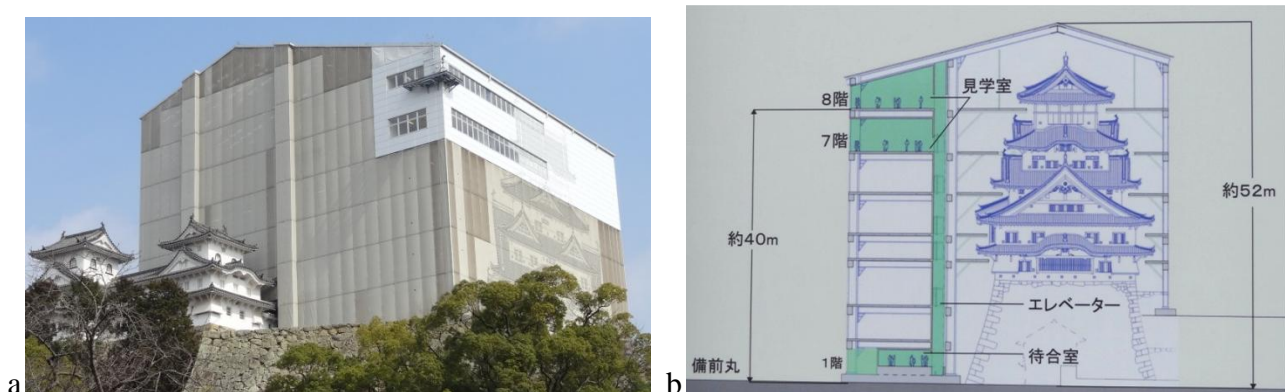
a : le donjon du château d'Himeji recouvert par un échafaudage en 2013 ; b : plan en coupe du même échafaudage.
